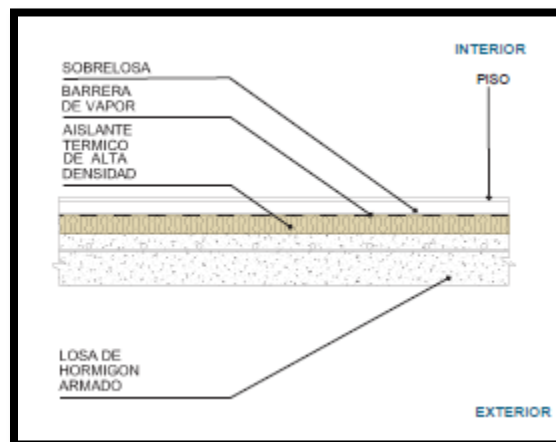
Piso con losa ventilado. Barrera de vapor y aislante térmico por el interior.
